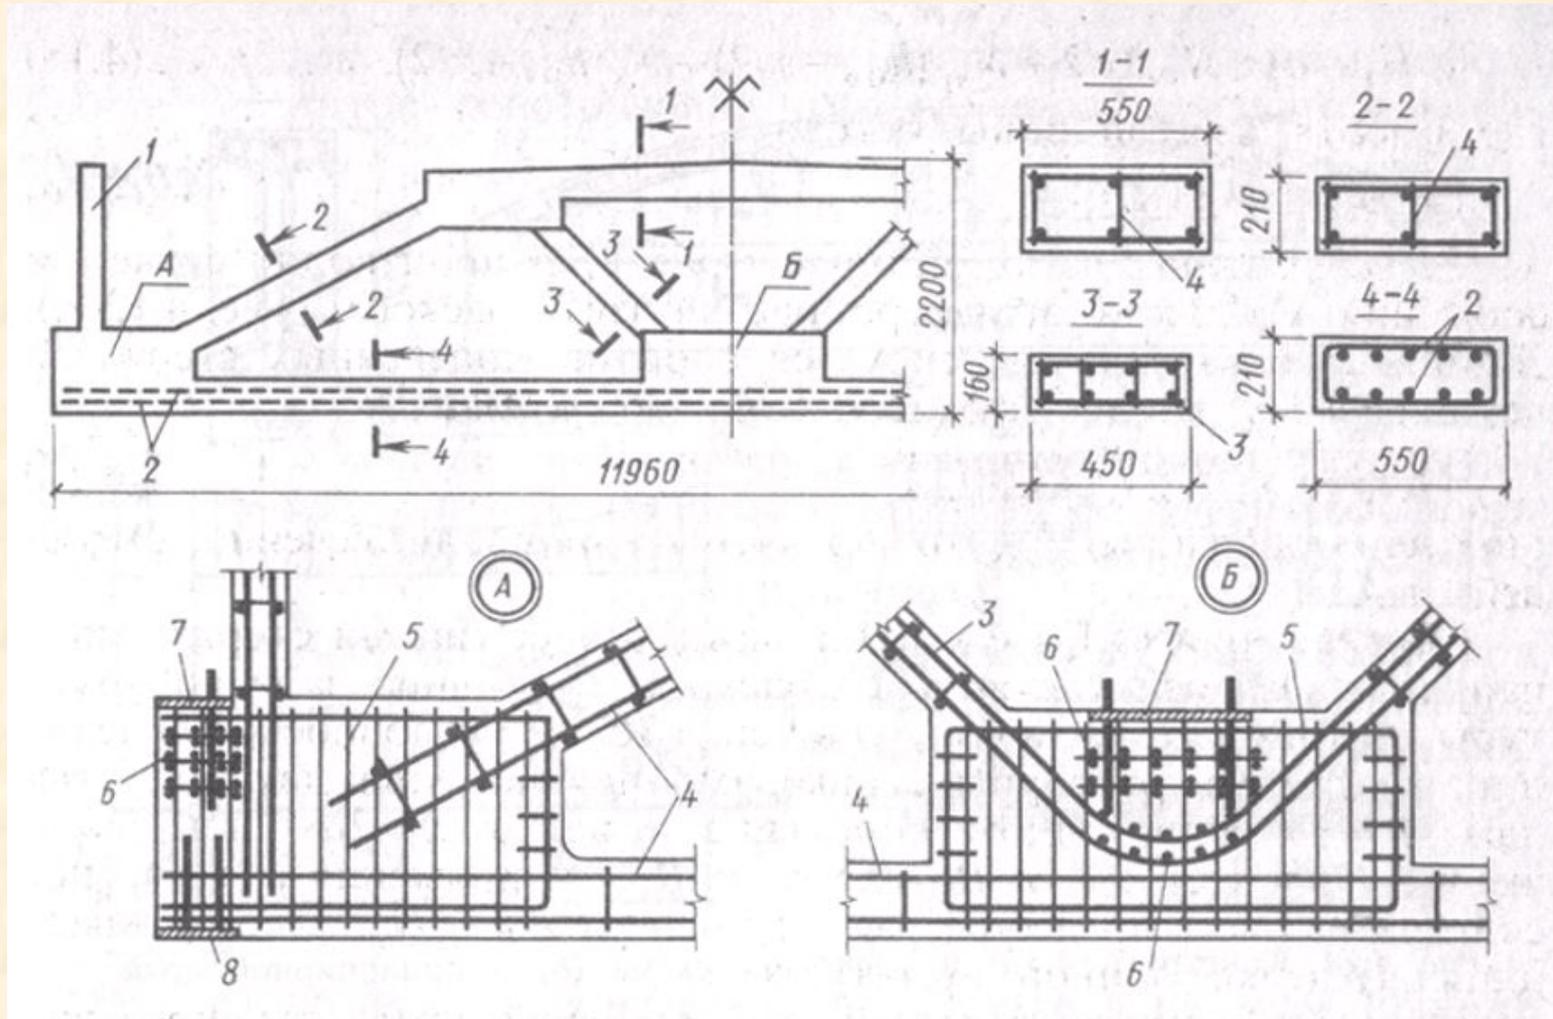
Конструкция (а) и армирование (б) подстропильной фермы
